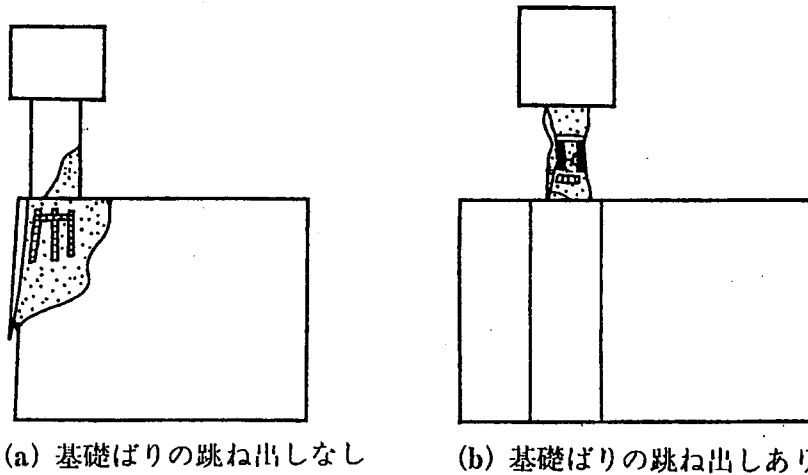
平面形状がL形で高強度コンクリートの柱と普通強度コンクリートの基礎梁の試験体の破壊状況
